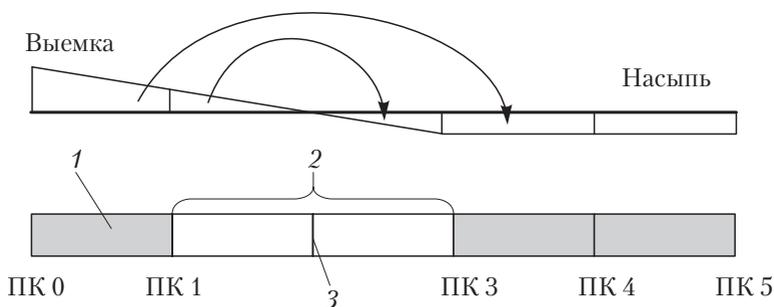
Схема перемещения грунта из выемки в насыпь при расположении выемки с края участка:
